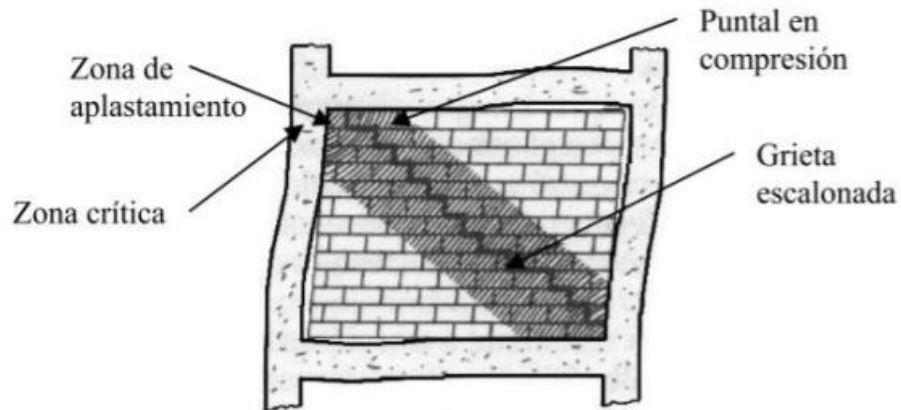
Falla del panel de mampostería por compresión diagonal
